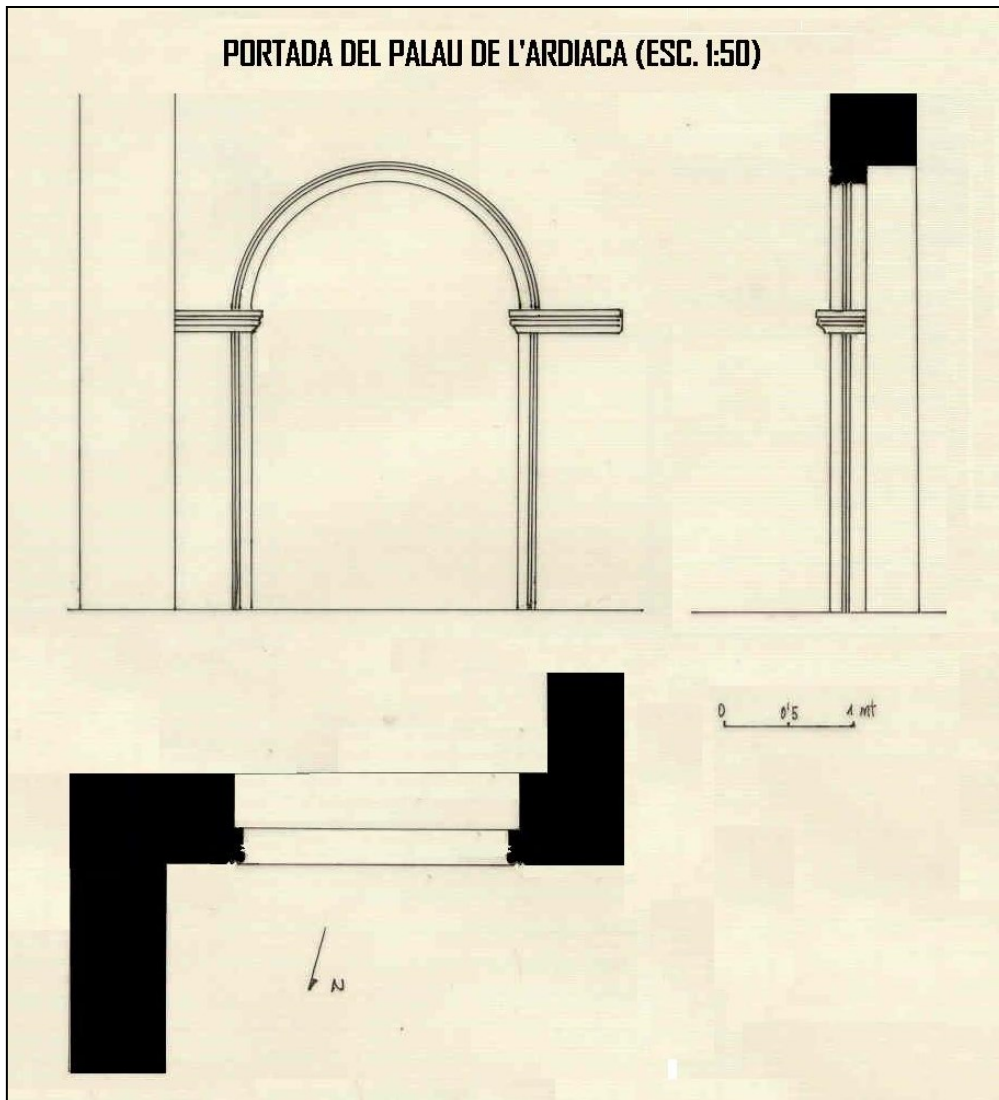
Diseño de la portada en alzado, planta y perfil (Francisco J. Soriano)
